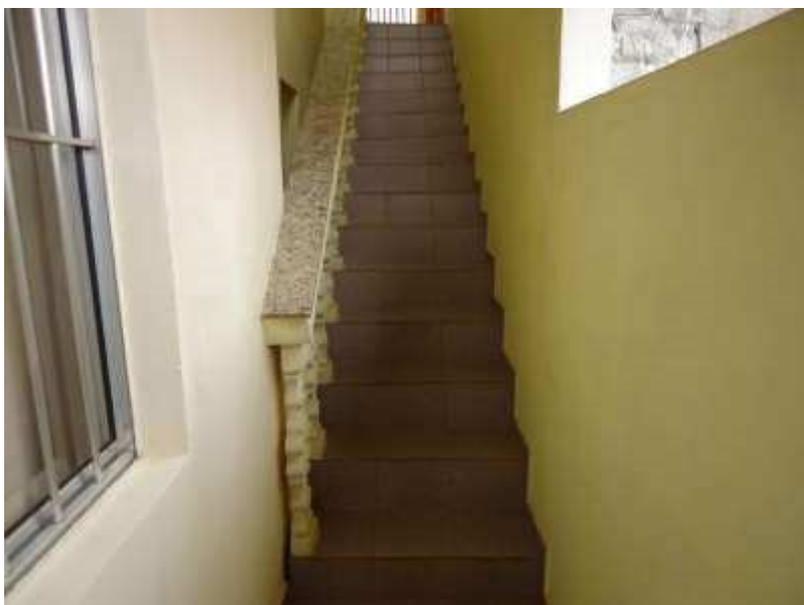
Detalhe externo da edificação – Escada Pav. Térreo p/ Pav. Inferior
